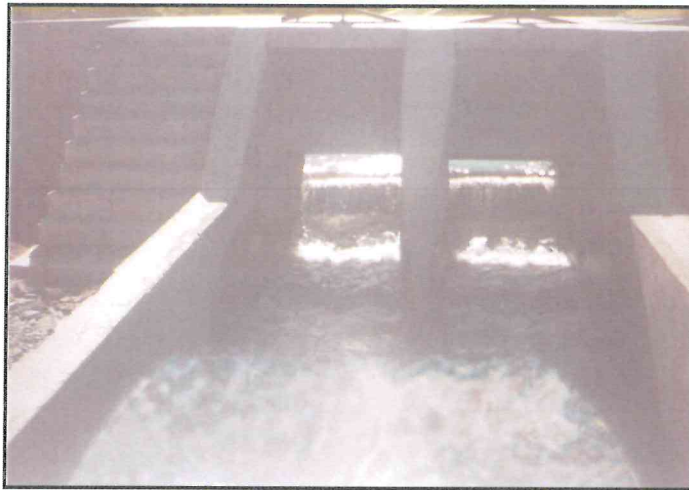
Vista desde aguas abajo de las compuertas de descarga Hacia el canal Cano –Salado.
